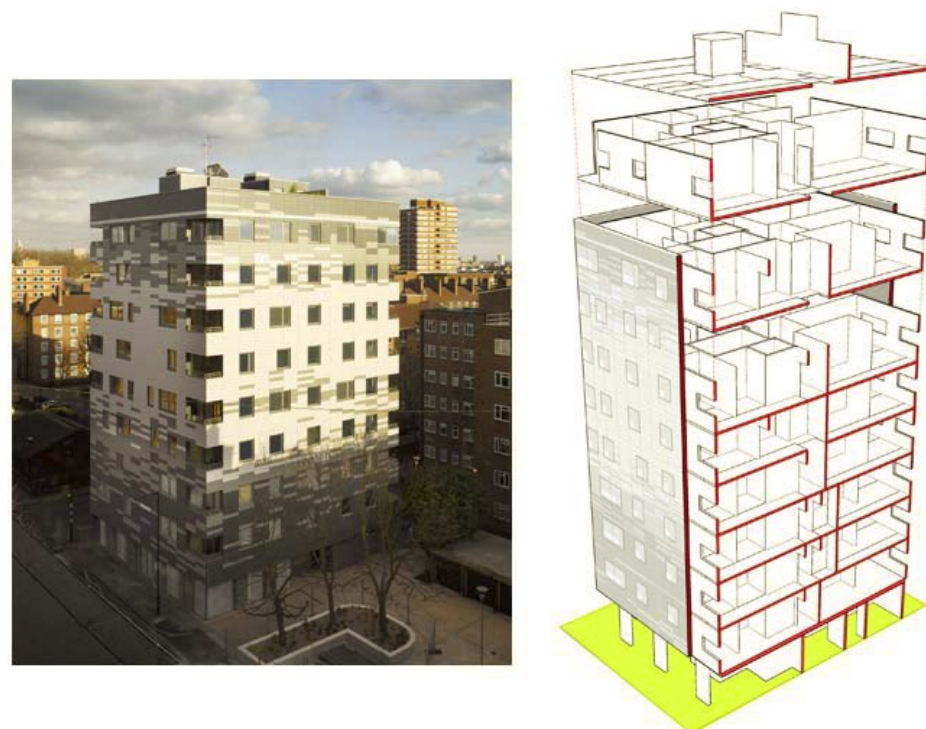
Edificio interamente a struttura di legno di 9 piani realizzato nel 2008 a Murray Grove, Londra su progetto dello studio Waugh-Thistleton. Tempo di realizzazione delle strutture: 9 settimane
